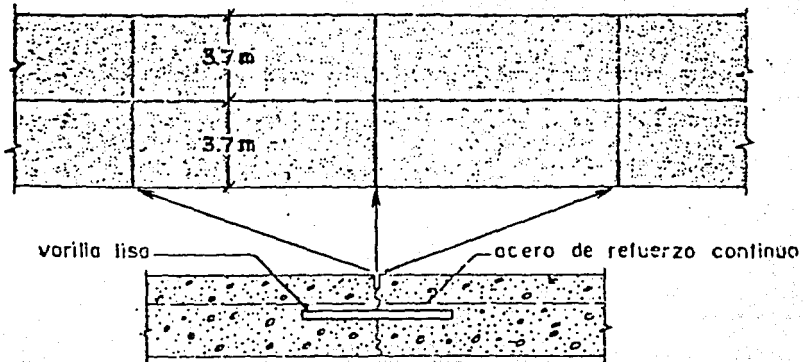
Juntas transversales - pavimentos con refuerzo continuo
